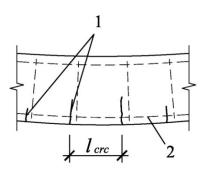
К определению расстояния между нормальными трещинами: 1 – нормальные трещины, 2 – продольная арматура
